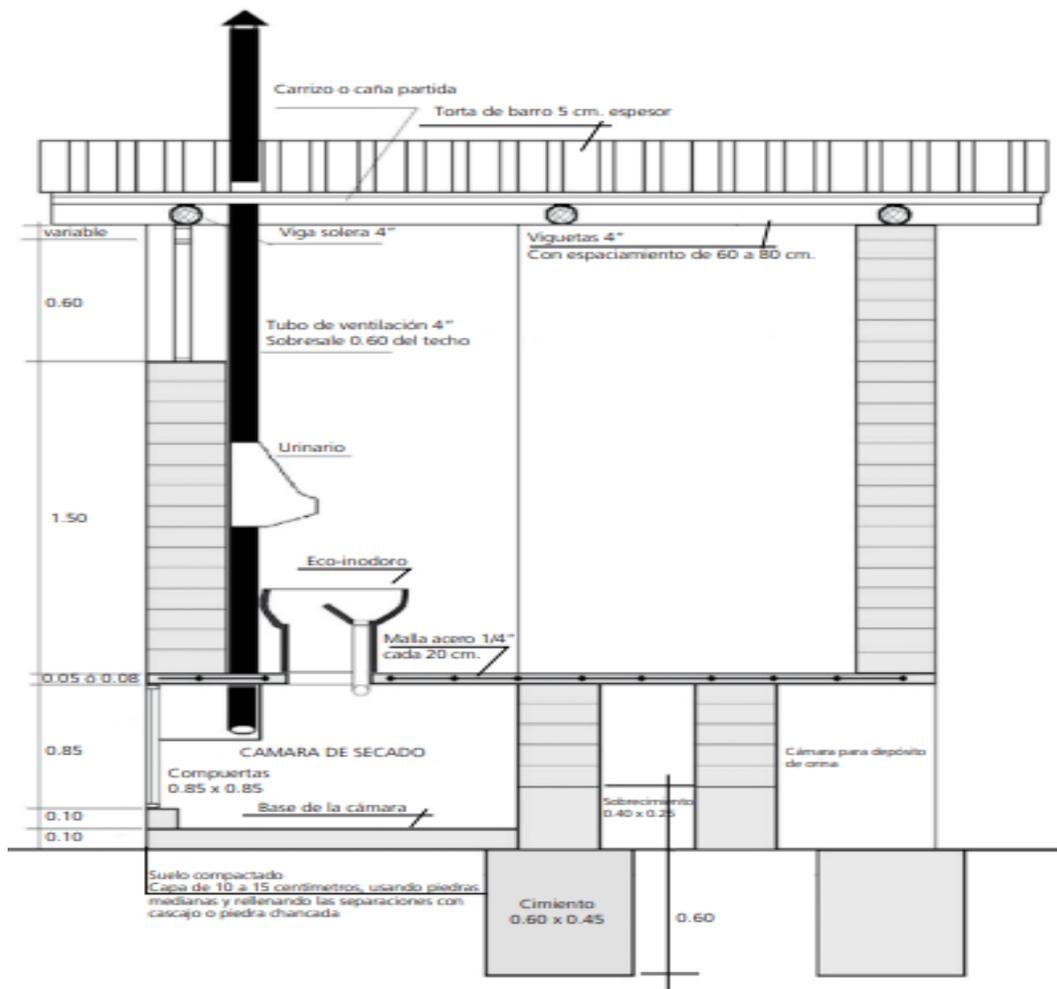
Propuesta de construcción de baño seco para las cabañas
